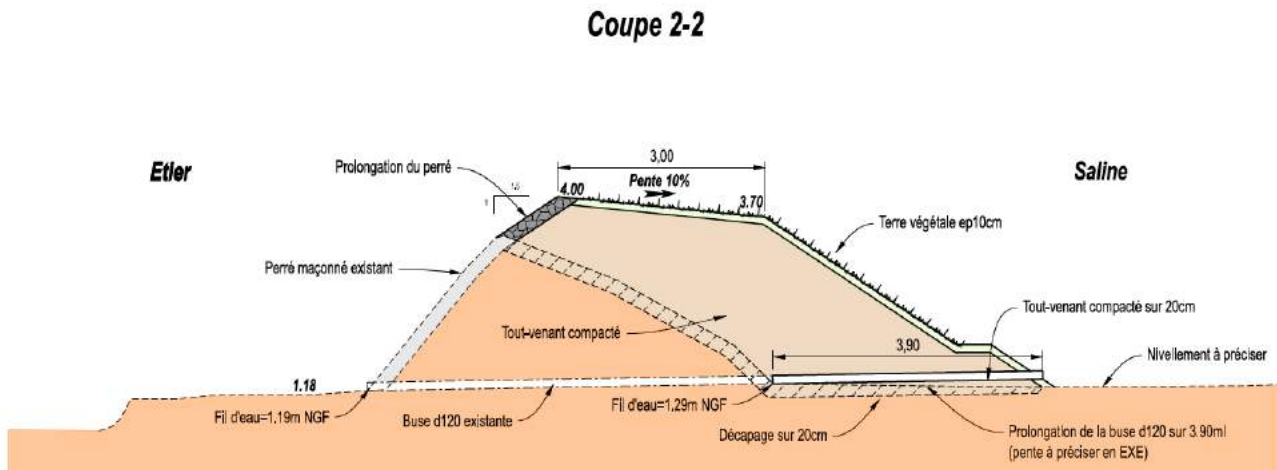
Coupe de principe des travaux au droit des ouvrages traversants à réaliser
